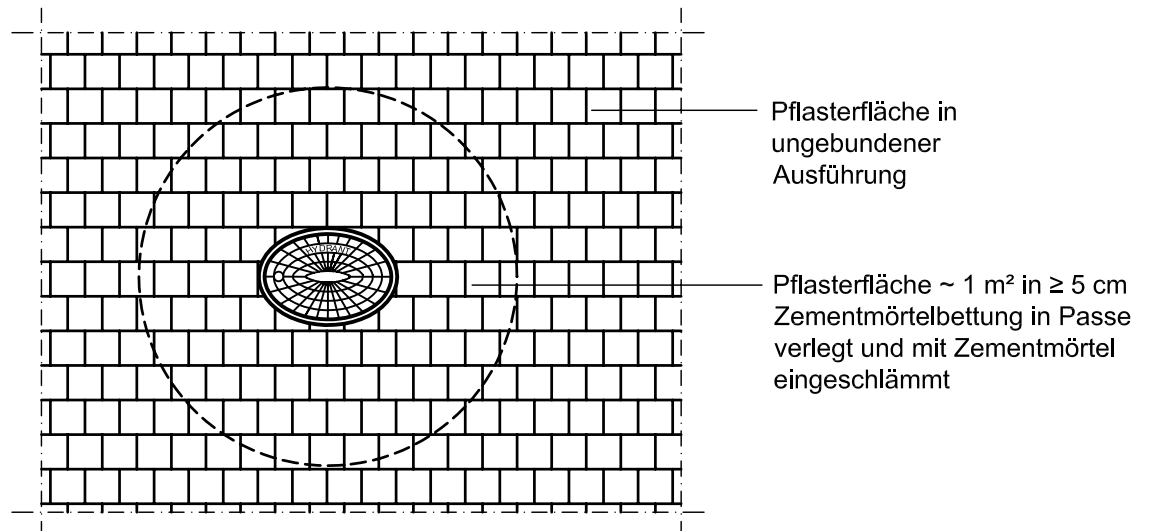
Hydrantenstraßenkappe in Pflasterfläche – dargestellt: Kleinpflaster
